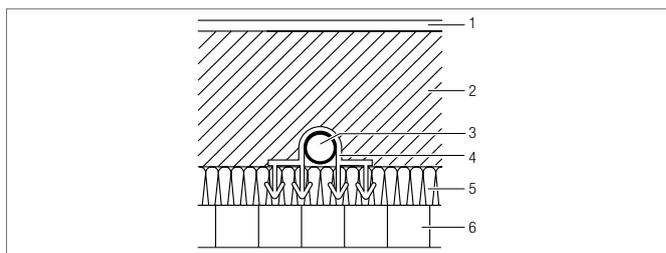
Struttura del pavimento senza isolamento aggiuntivo
